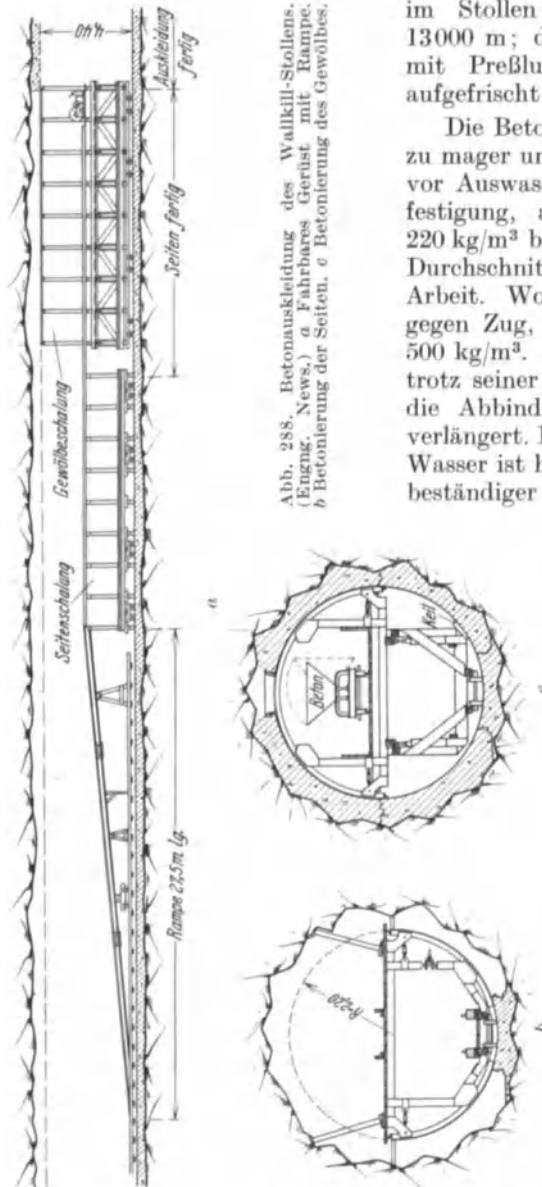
Betonauskleidung des Walkhüll-Stollens. (Engng. News.) a) Fahrbares Gerüst mit Rampe. b) Betonierung der Seiten. c) Betonierung des Gewölbes.
